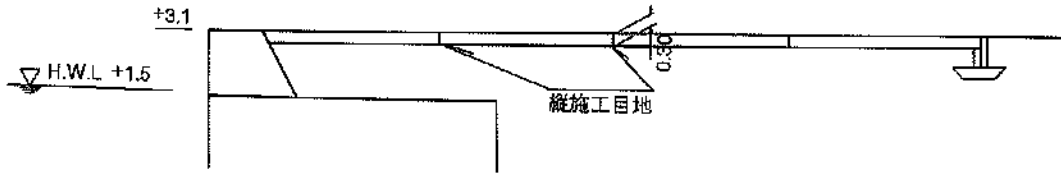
被災状況断面図 (十勝港, ①岸壁(南-7.5m))
